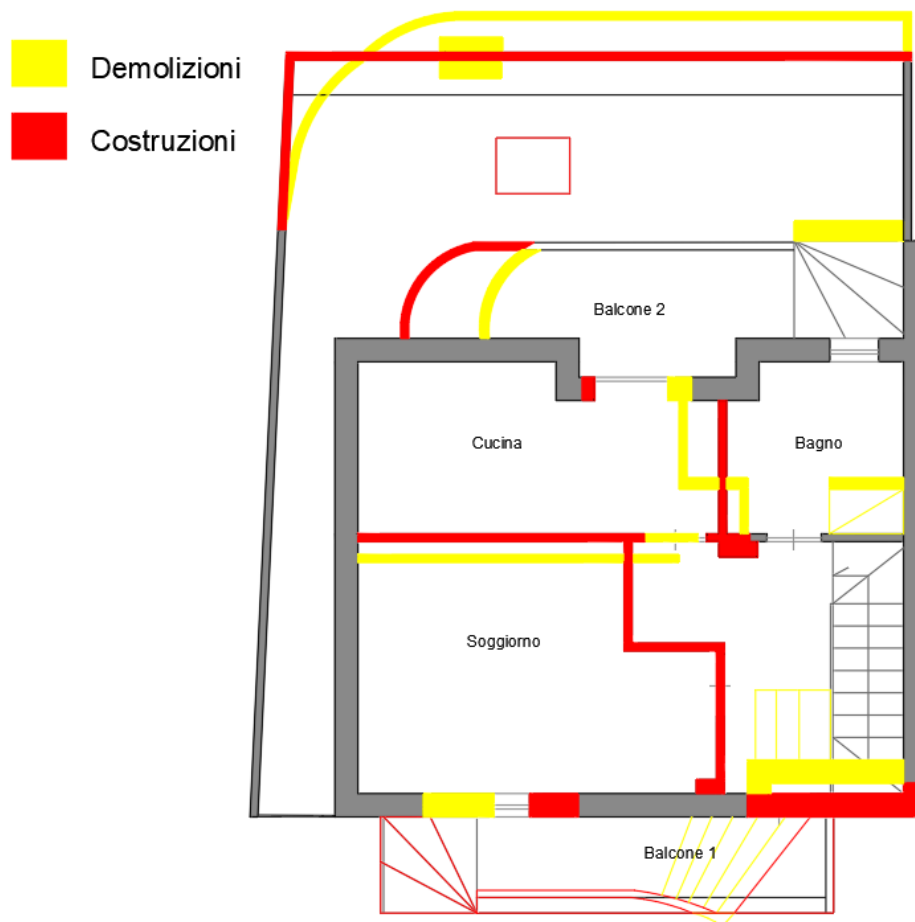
Confronto Edilizio con Variante alla C.E. n. 40949/2005 – Pianta Piano Terra
